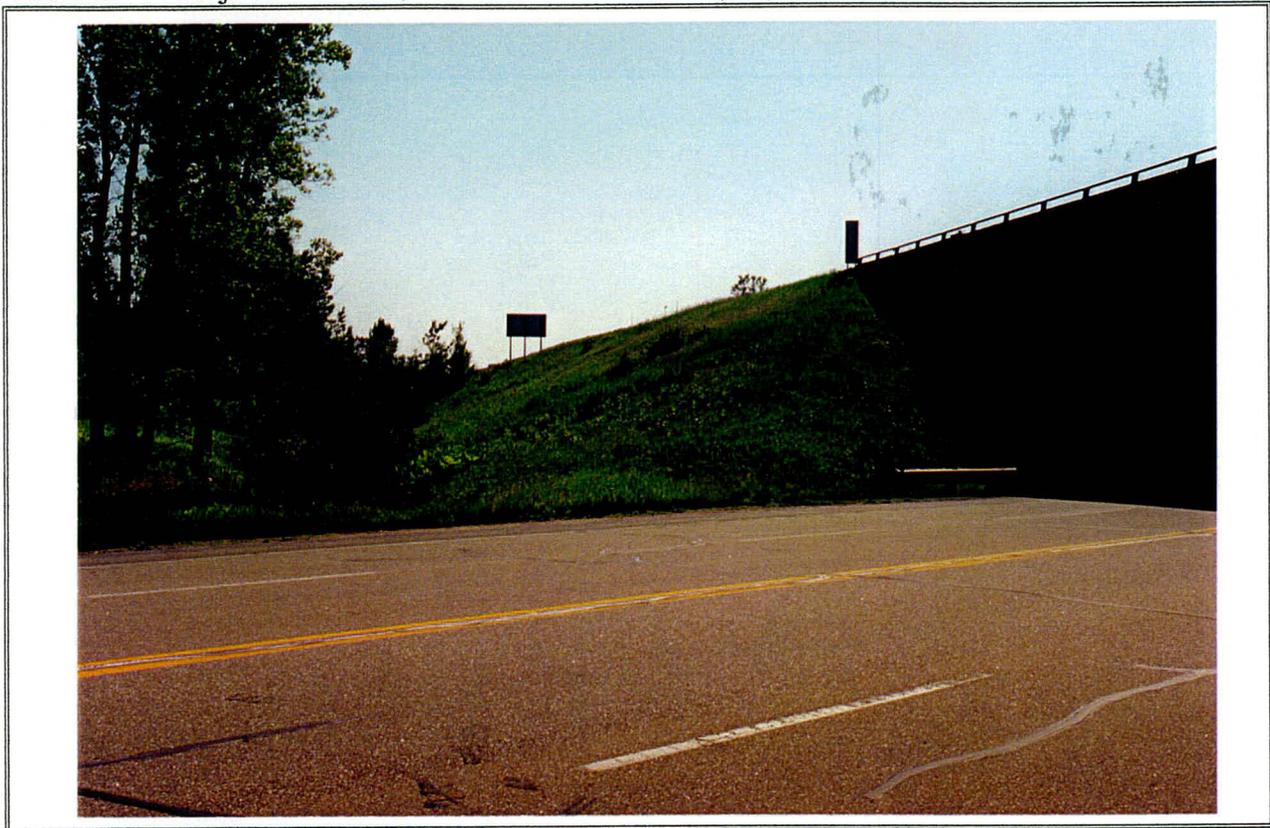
Projet 6373-9717, autoroute 40/route 138 (SO)
